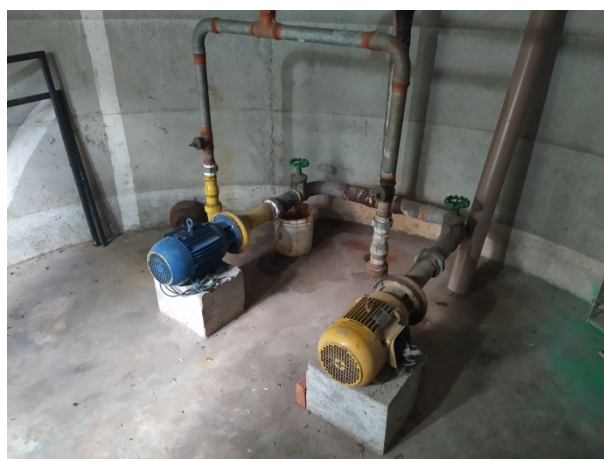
Detalhe dos conjuntos Moto-Bomba GI.
